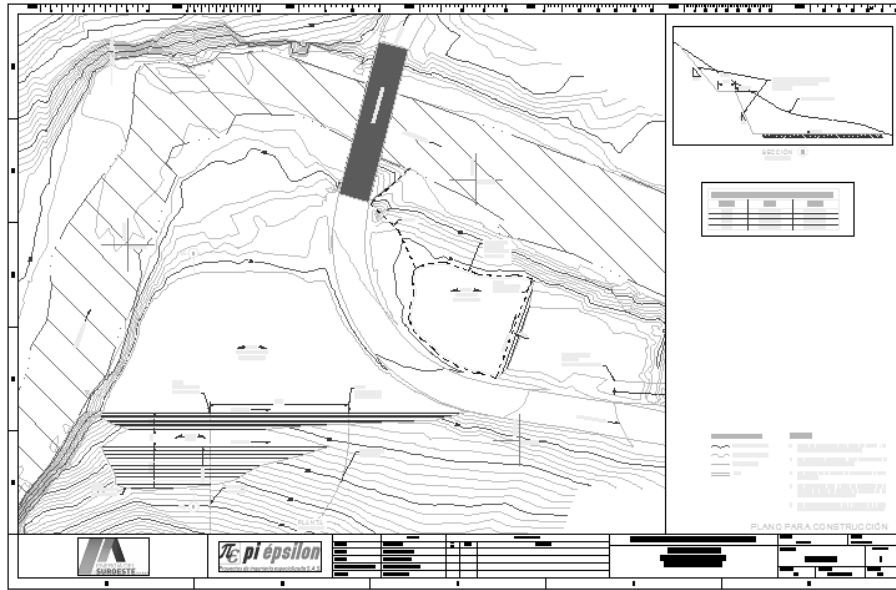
Plano de excavaciones de la zona de casa de máquinas
